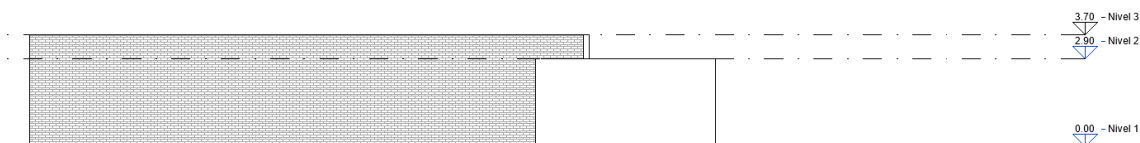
Alzado Norte modelo levantamiento con Dron LiDAR. Fuente: elaboración propia.
